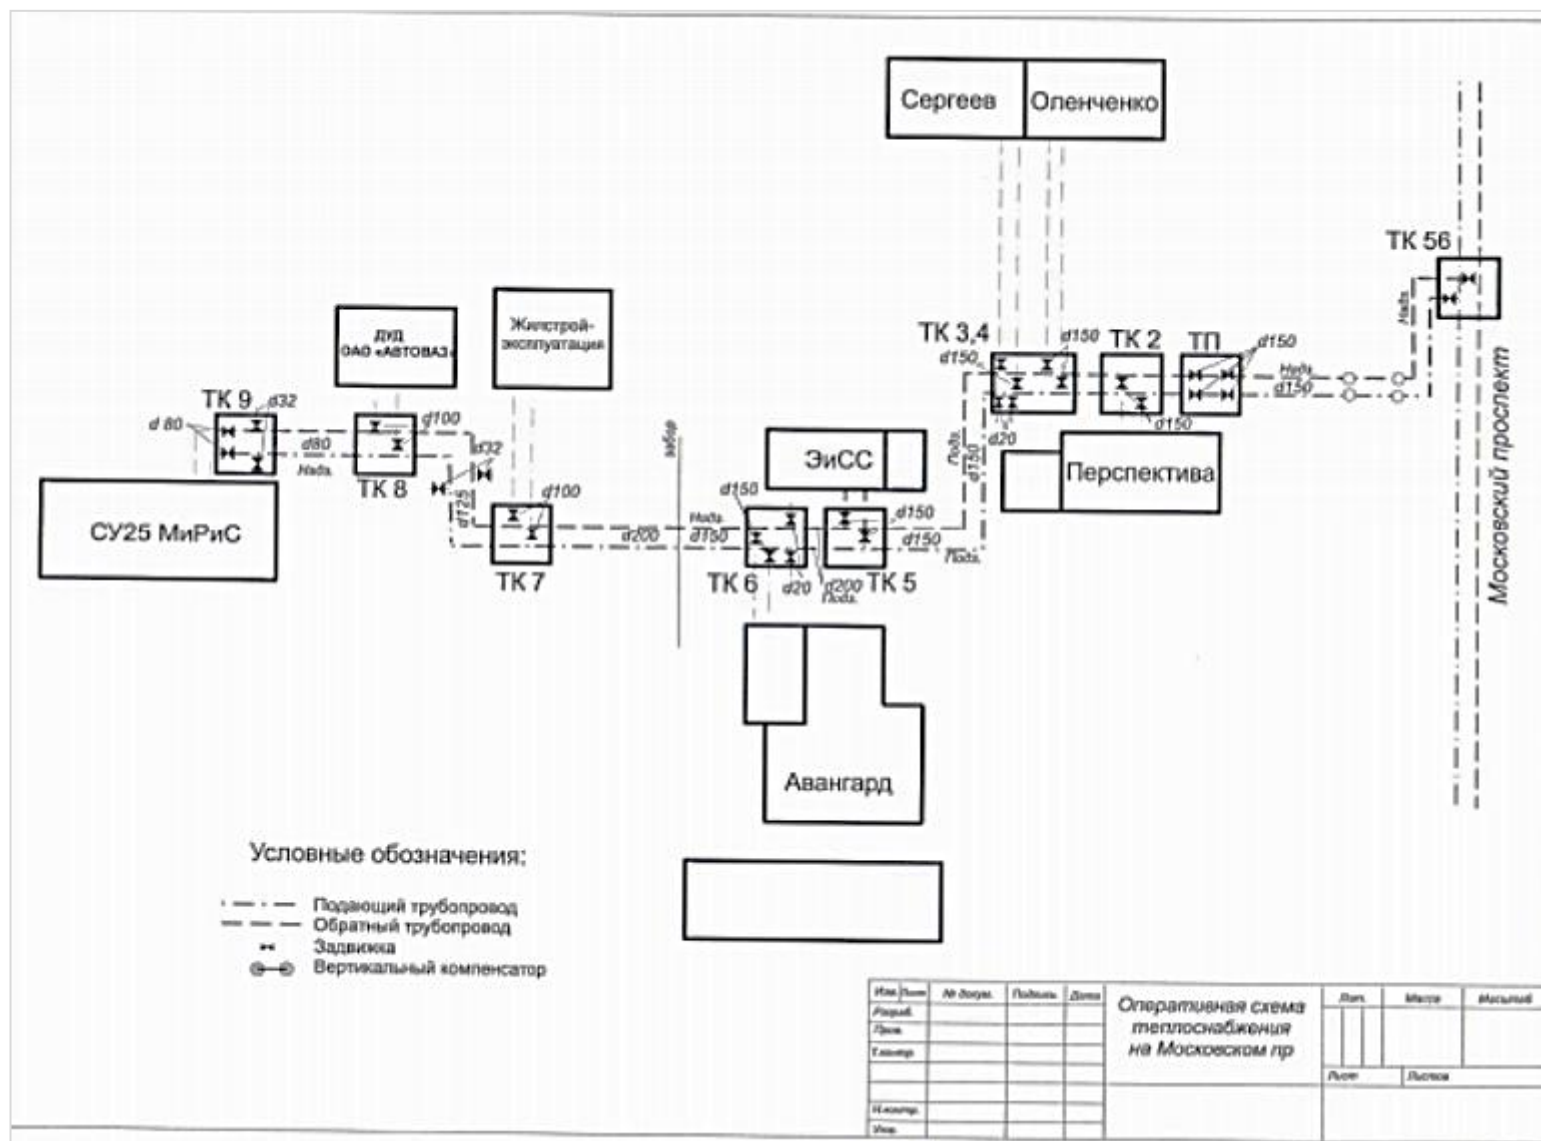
Схема трубопроводов тепловых сетей, от ТК-56
